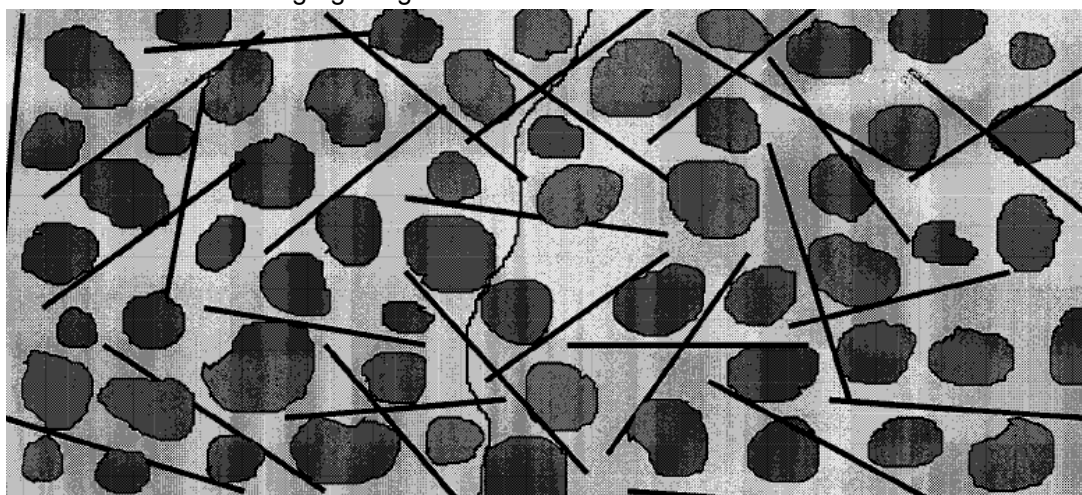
Mecanismo de controle de fissuras
